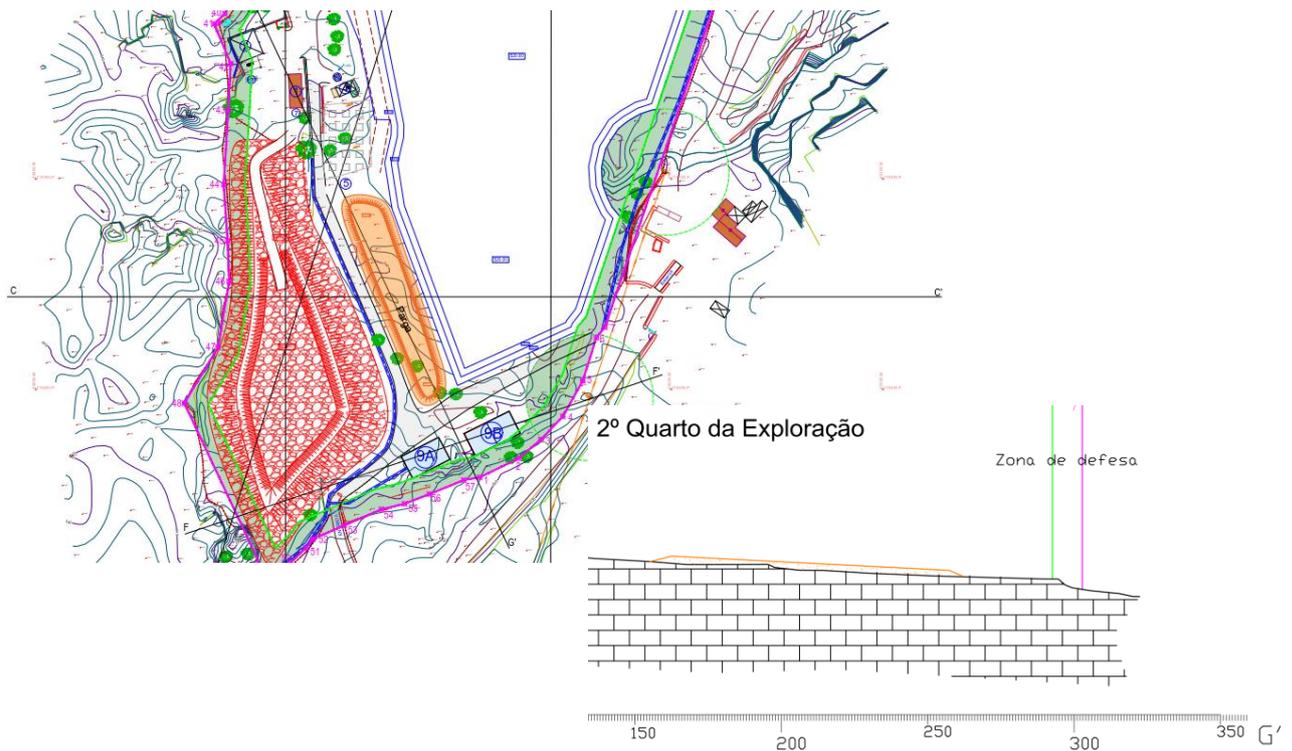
Pormenor da localização e perfis da Parga de Solos (perfil G-G').
